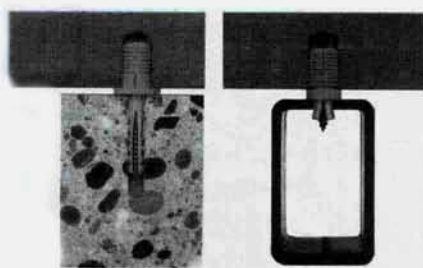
Крепление деревянной ступени к бетонной и профильной стальной опорной конструкции с помощью пластмассовой втулки.
